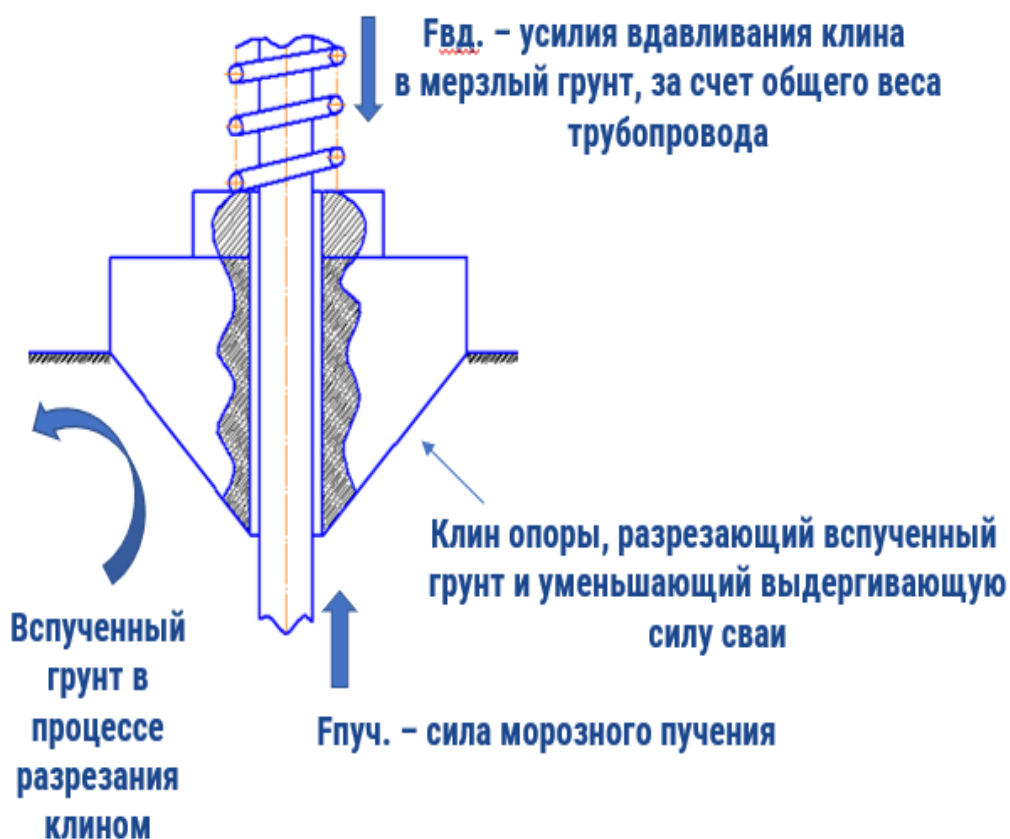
Схема элементов конструкции опоры в разрезе
